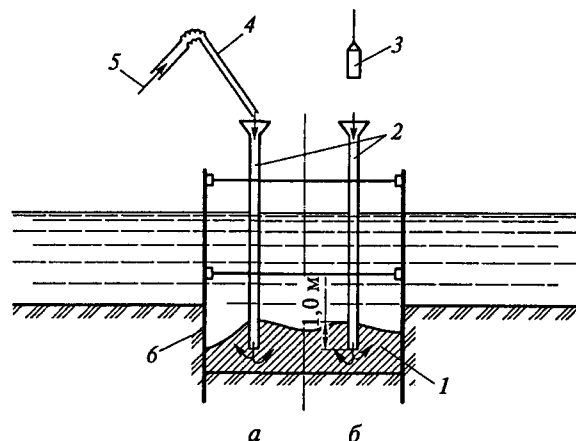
Схема подводного бетонирования методом вертикально перемещающихся труб:
